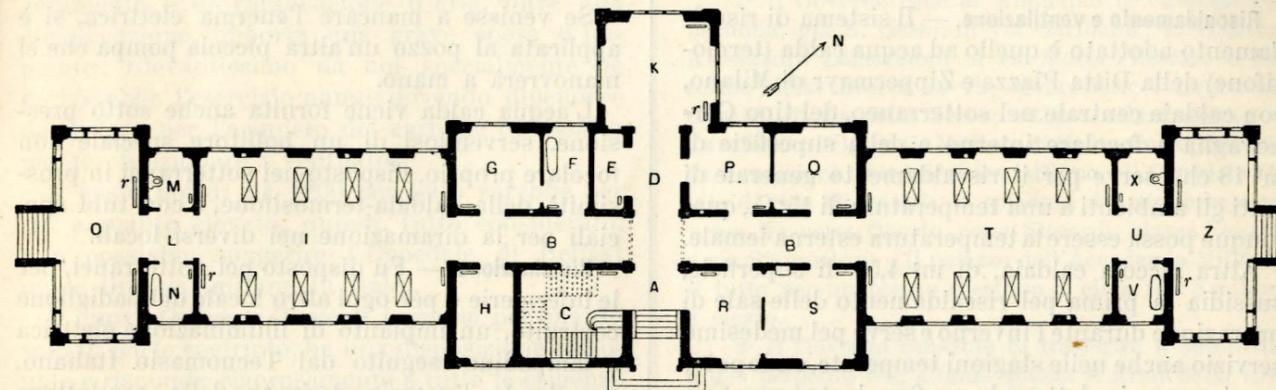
Pianta del piano terreno (Scala 1:410).
